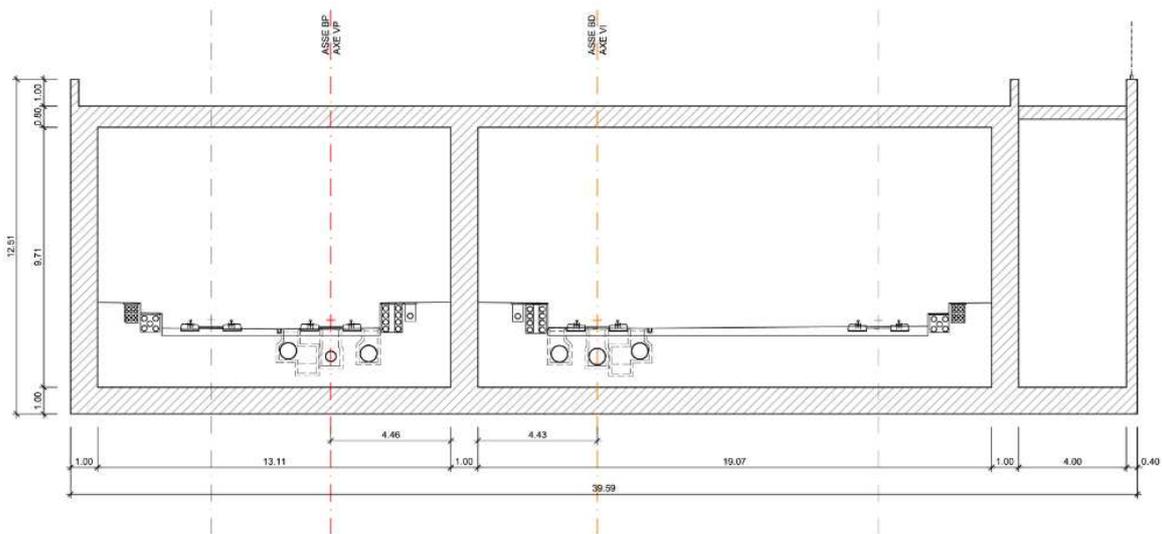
Sezione tipo galleria artificiale BP pk 61+116.52 – 61+196
